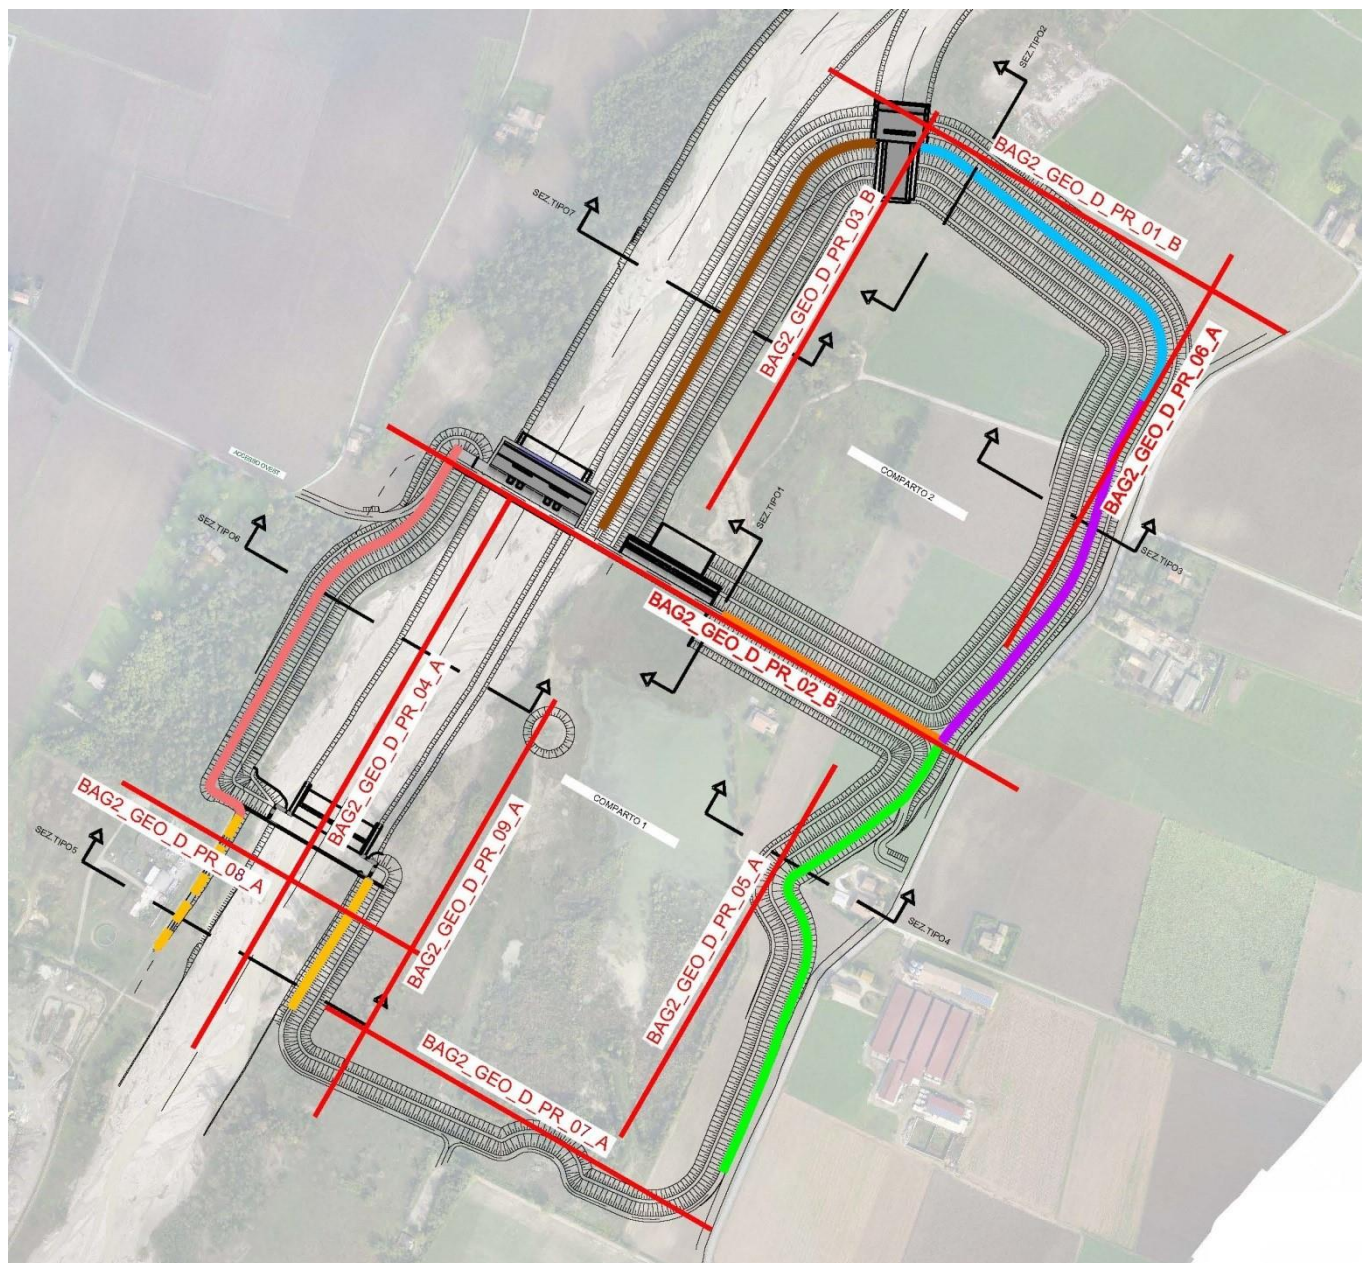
Planimetria schematica dei profili geotecnici e dei manufatti
